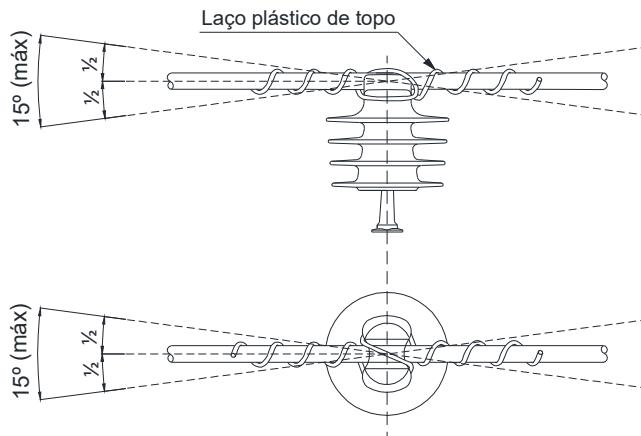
Amarrações e ligações – Amarração de topo do cabo protegido – Laço plástico
